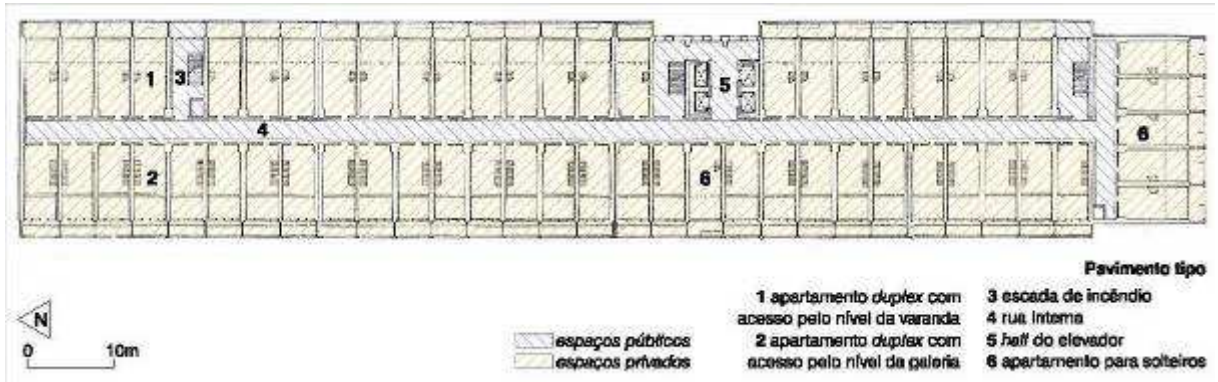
Planta do pavimento tipo com rua interna: níveis 2, 5, 10, 13 e 16. (FONTE: Adaptado de JENKINS, 1999)
